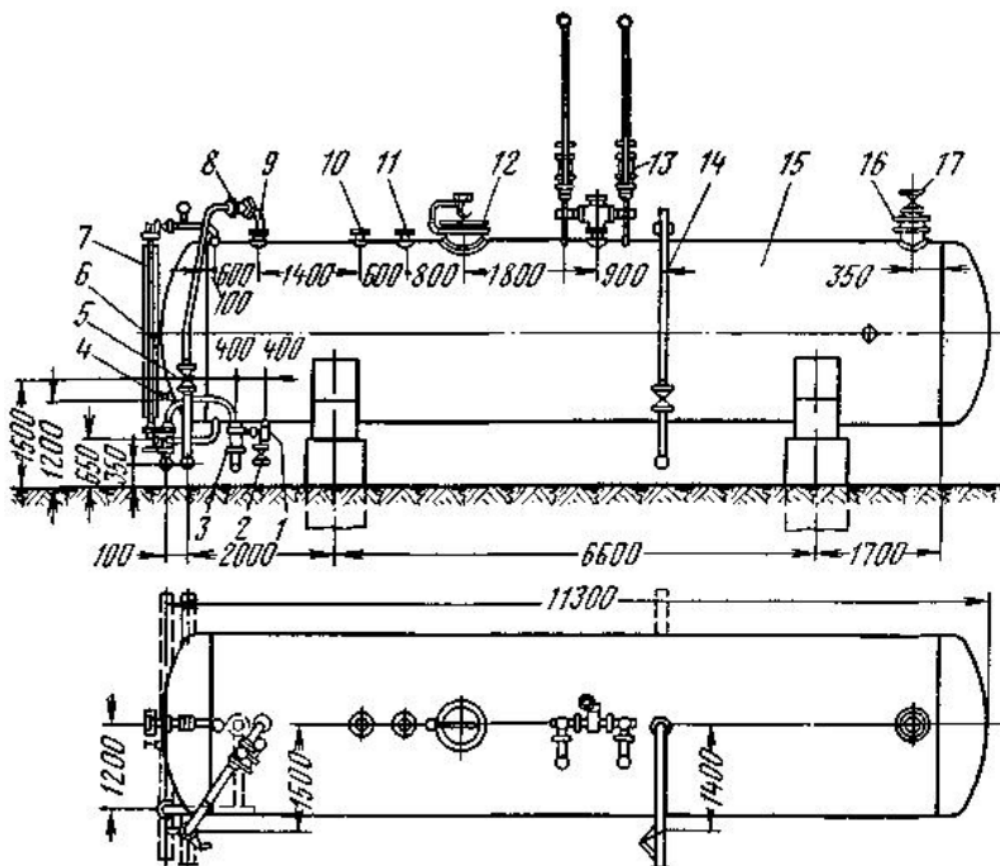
Схема установки и обвязки надземного цилиндрического резервуара
